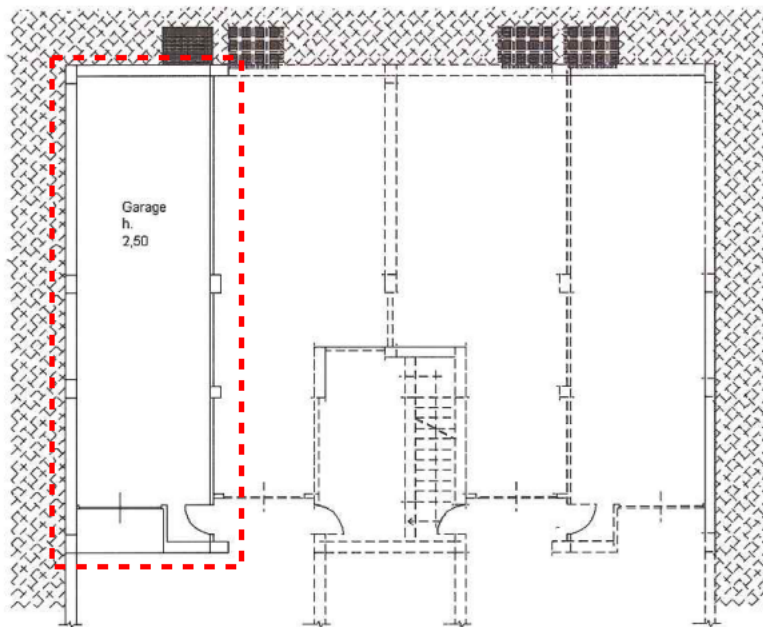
Elaborato planimetro F 54 P 1257 Sub.8 – Sub 2
